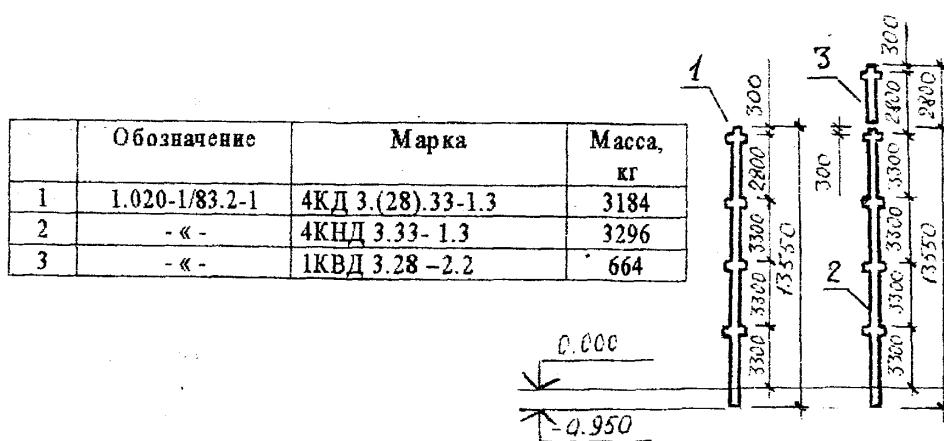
Колонны каркаса сечением 300х300 мм для зданий без подвала с высотой этажей 3300 мм и высотой верхнего этажа 2.800
